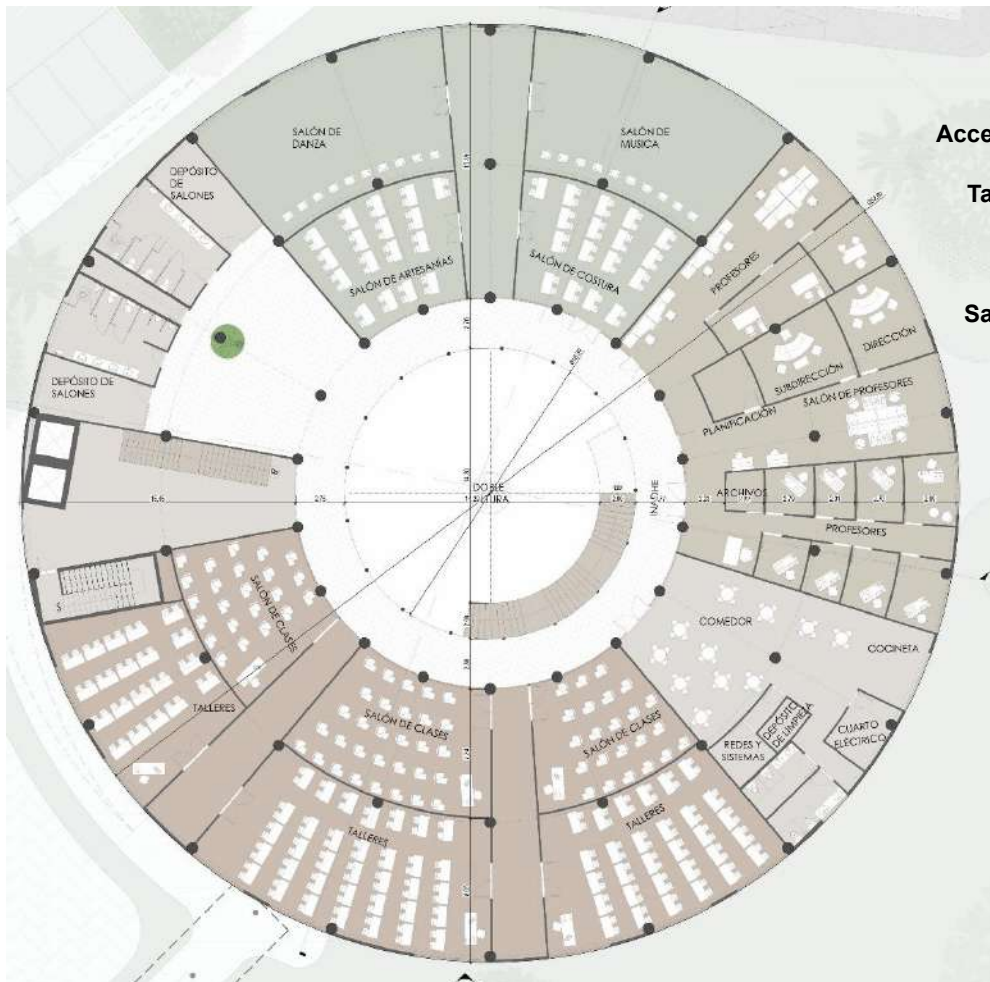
Ampliación de la planta alta de la torre C. Fuente: elaboración propia 2025
